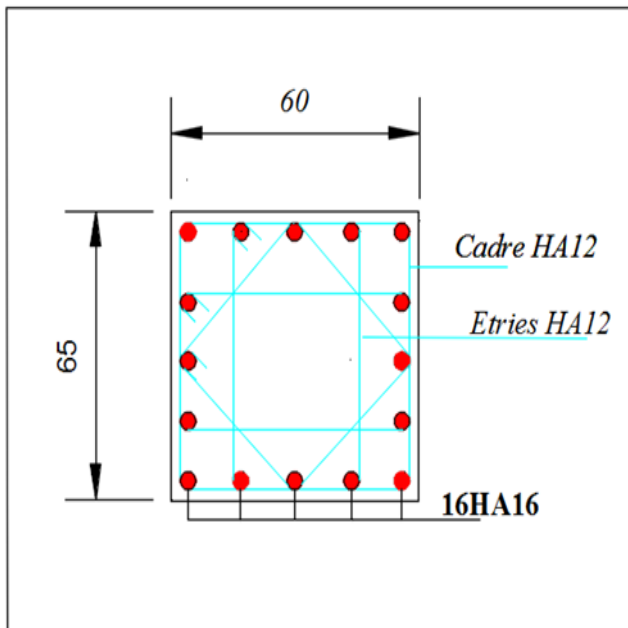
schéma de ferrailage des poteaux 2, 3^{ème} étages.
